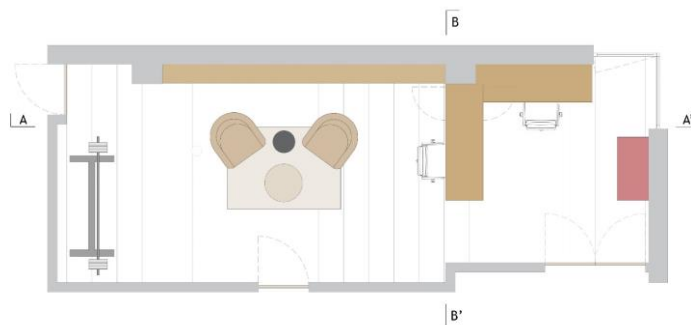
Proposta Inicial da planta. Fonte: Autora.
